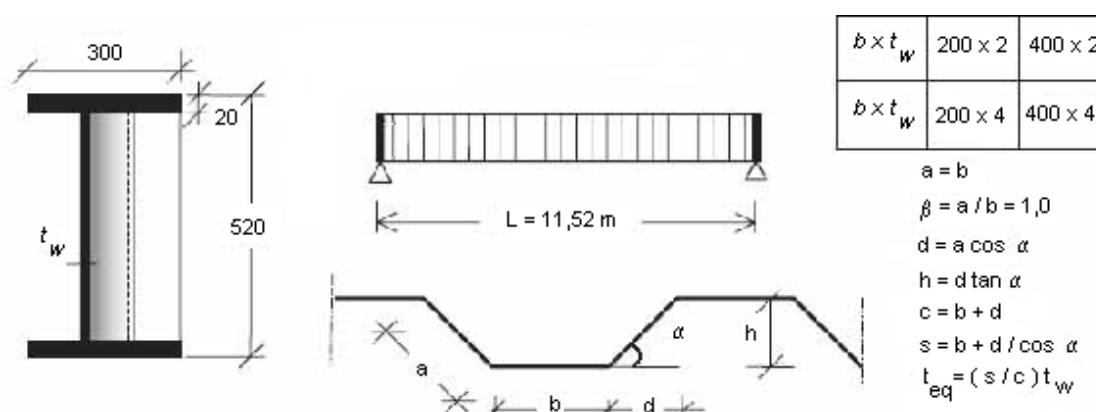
Dimensões usadas nas vigas com alma corrugada trapezoidal usadas por SAYED-AHMED (2005a)
